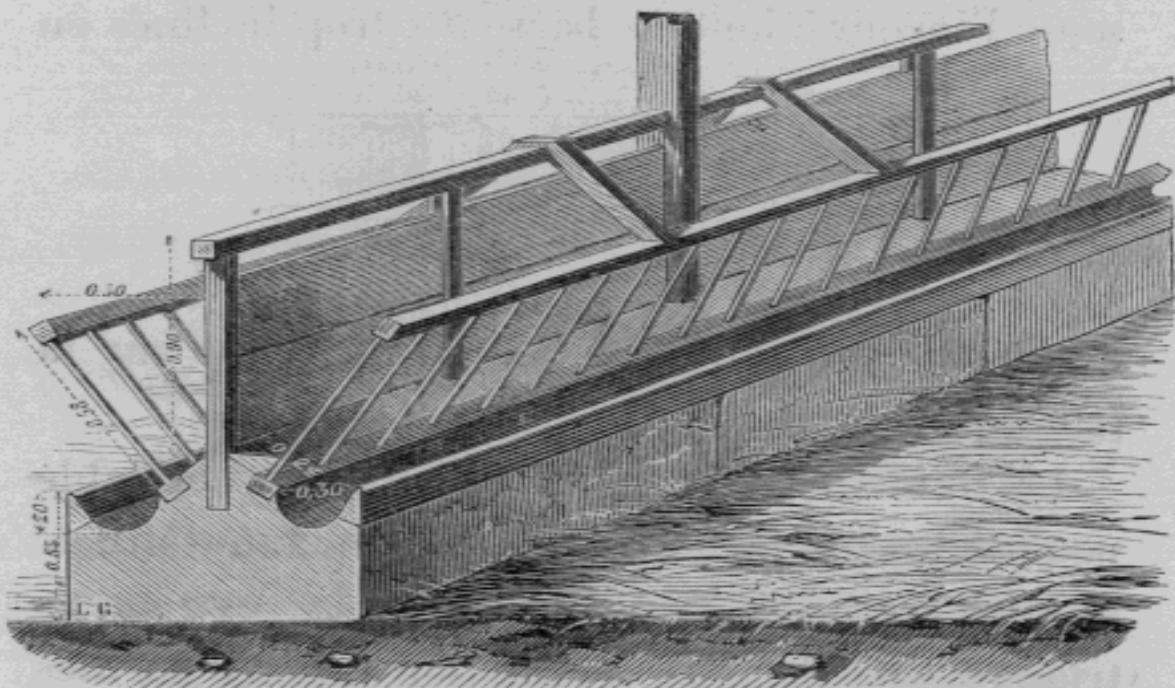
Vue perspective avec coupe transversale de la crèche de M. Vallerand de Moufflaye.
